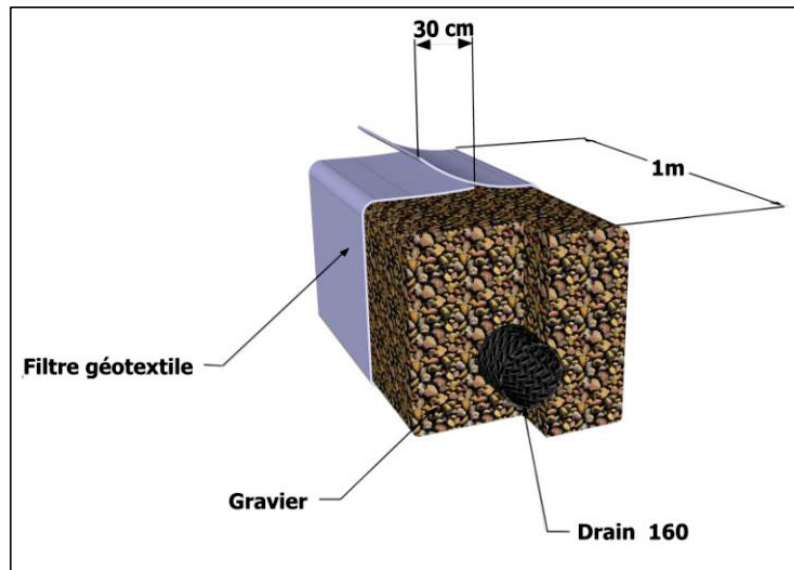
Détail constitutif d'une unité de longueur d'une tranchée drainante.
